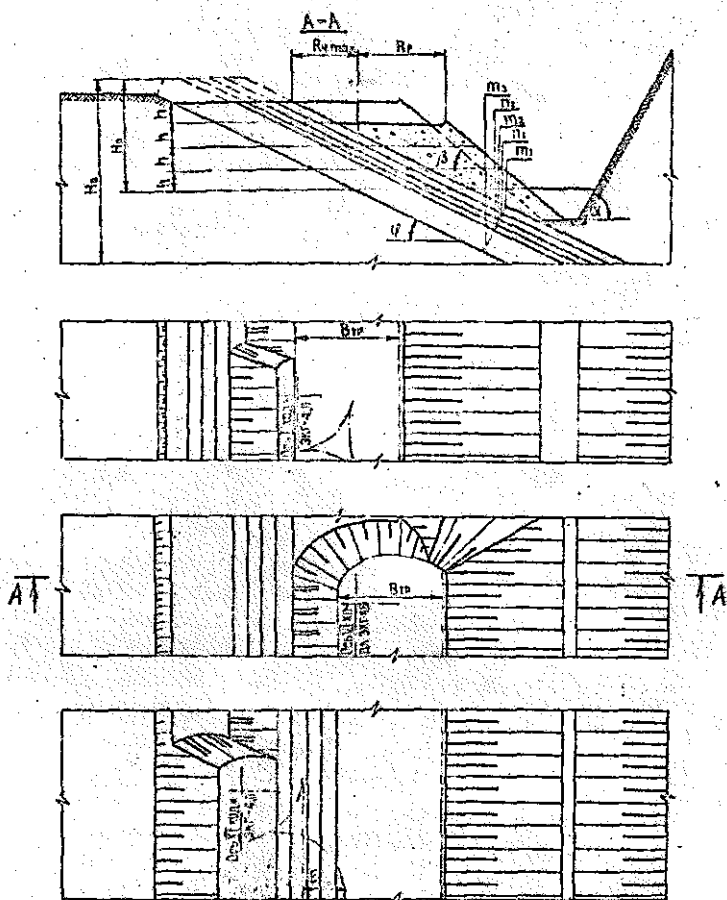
Технология разработки наклонного пласта горизонтальными слоями прямой лопатой с перезеканием взорванной породы в кровле пласта
